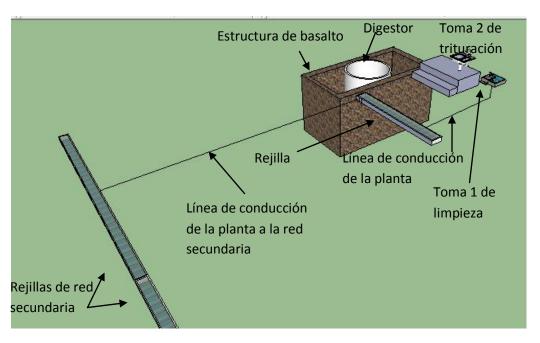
Vista isométrica del drenaje de la planta de biogás
